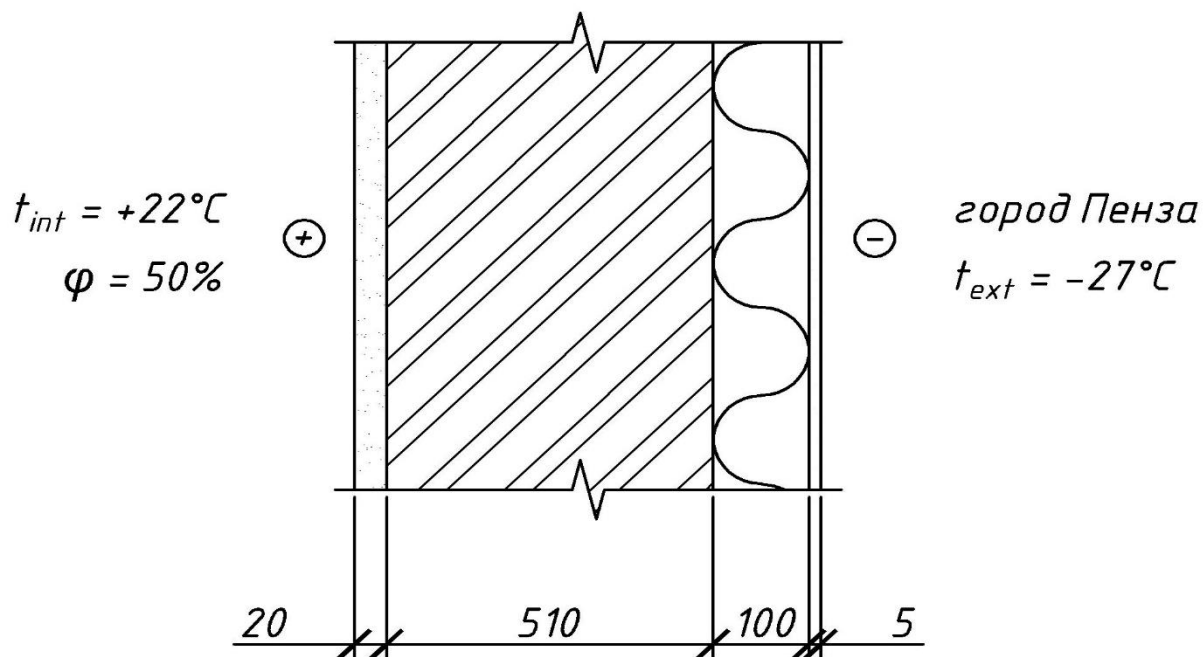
Конструкция утепления стены снаружи с использованием в качестве утеплителя плит из пенополистирола.
